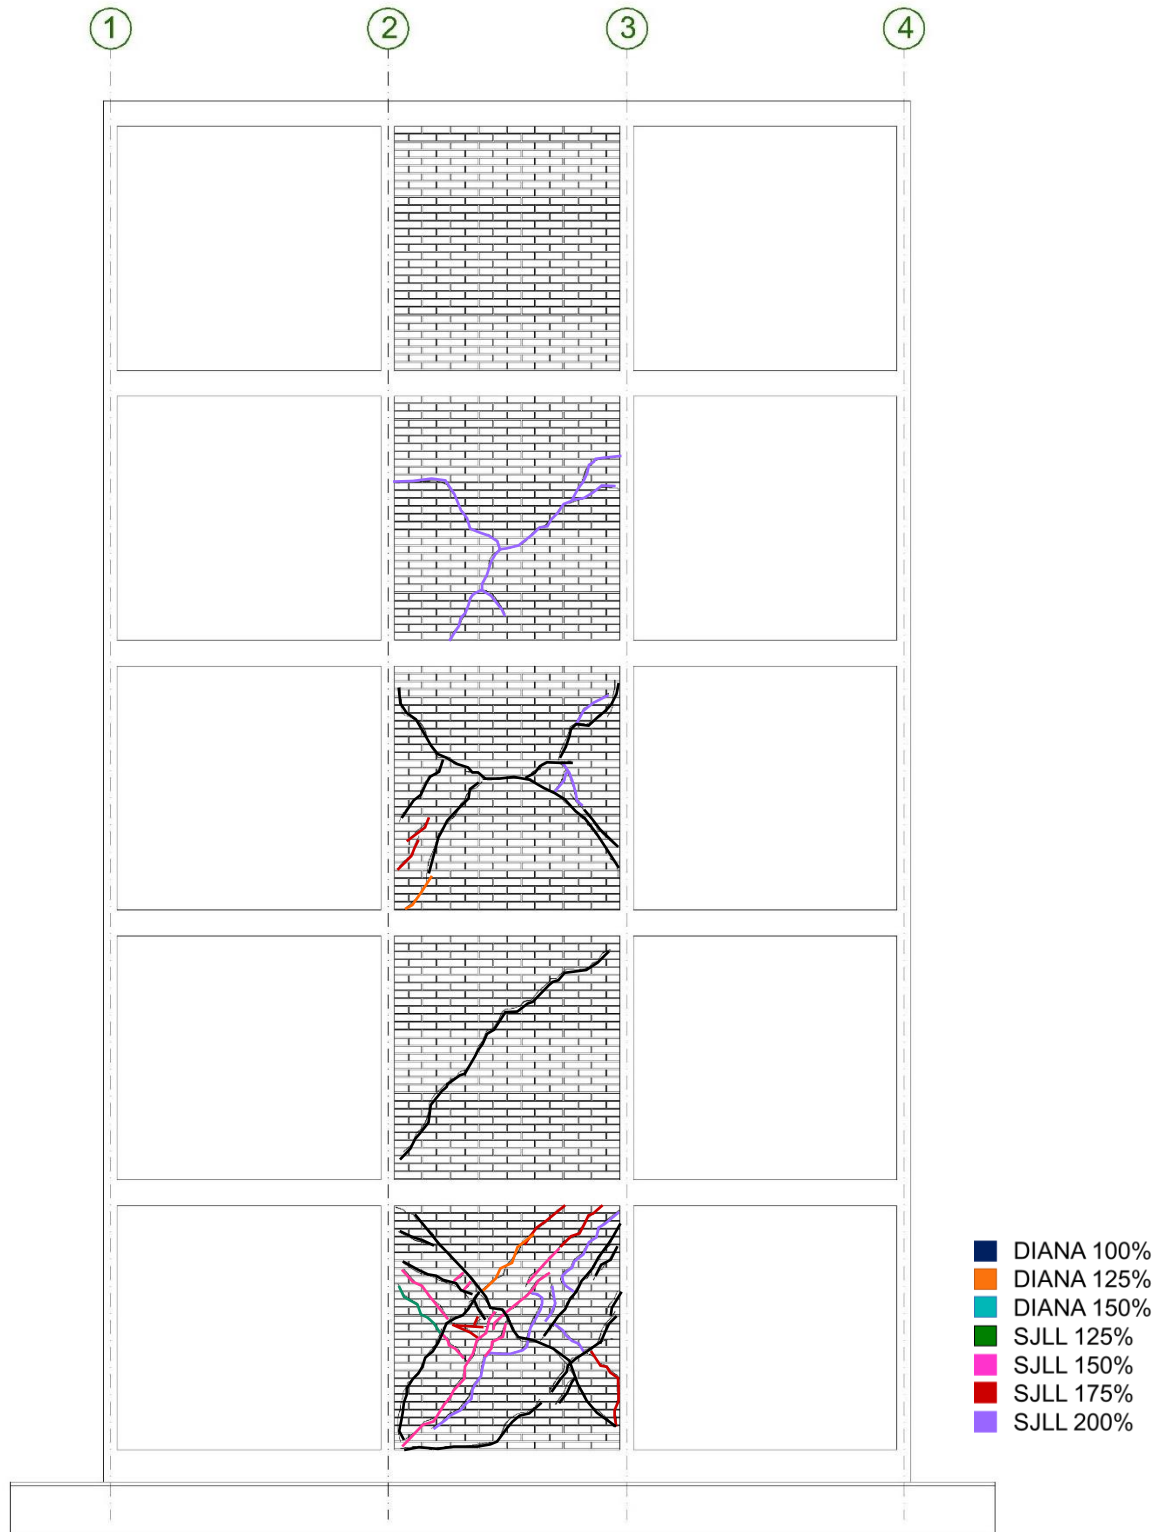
Estado general de daño del modelo con refuerzo en cimentación en muros centrales
